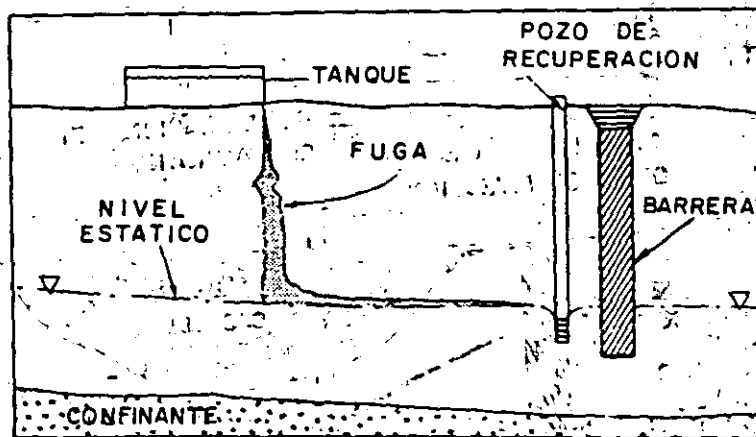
BARRERA PARA AISLAMIENTO DE ZONAS CONTAMINADAS
